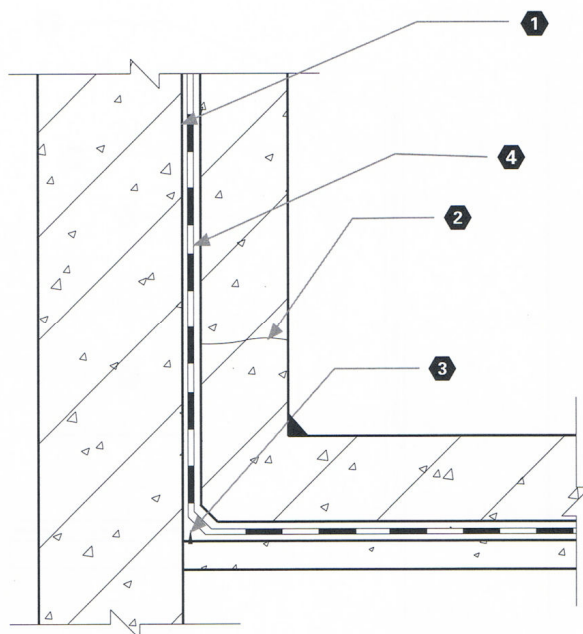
Esquema de aplicação em fundações de parede/pilar
